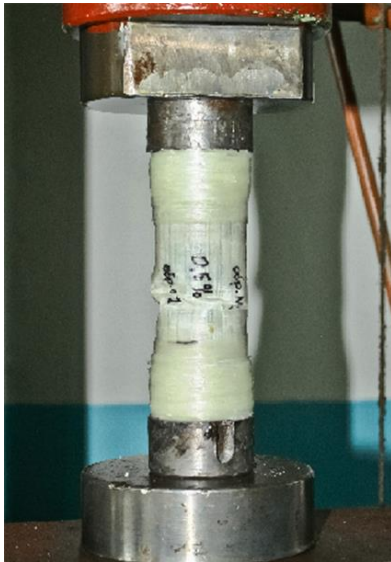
Образец трубчатого элемента в приспособлении для испытаний
